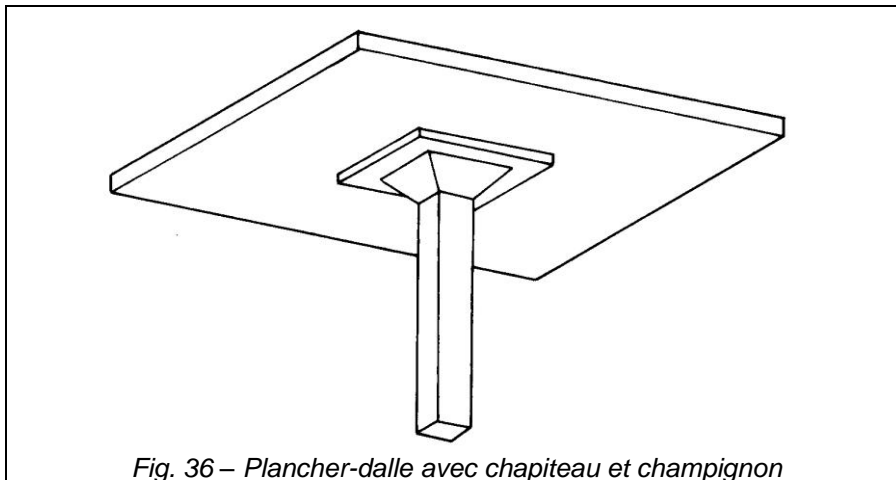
Plancher-dalle avec chapiteau et champignon
